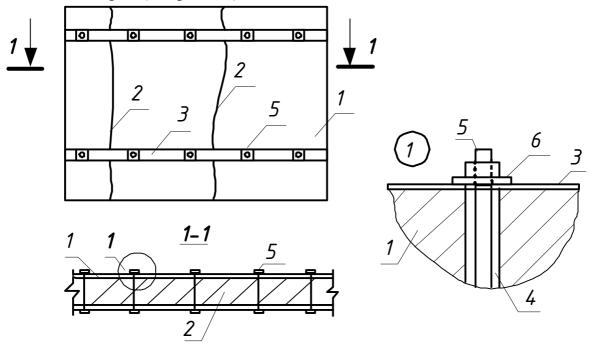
Установка металлических полос и предварительно напряженных железобетонных анкеров:
